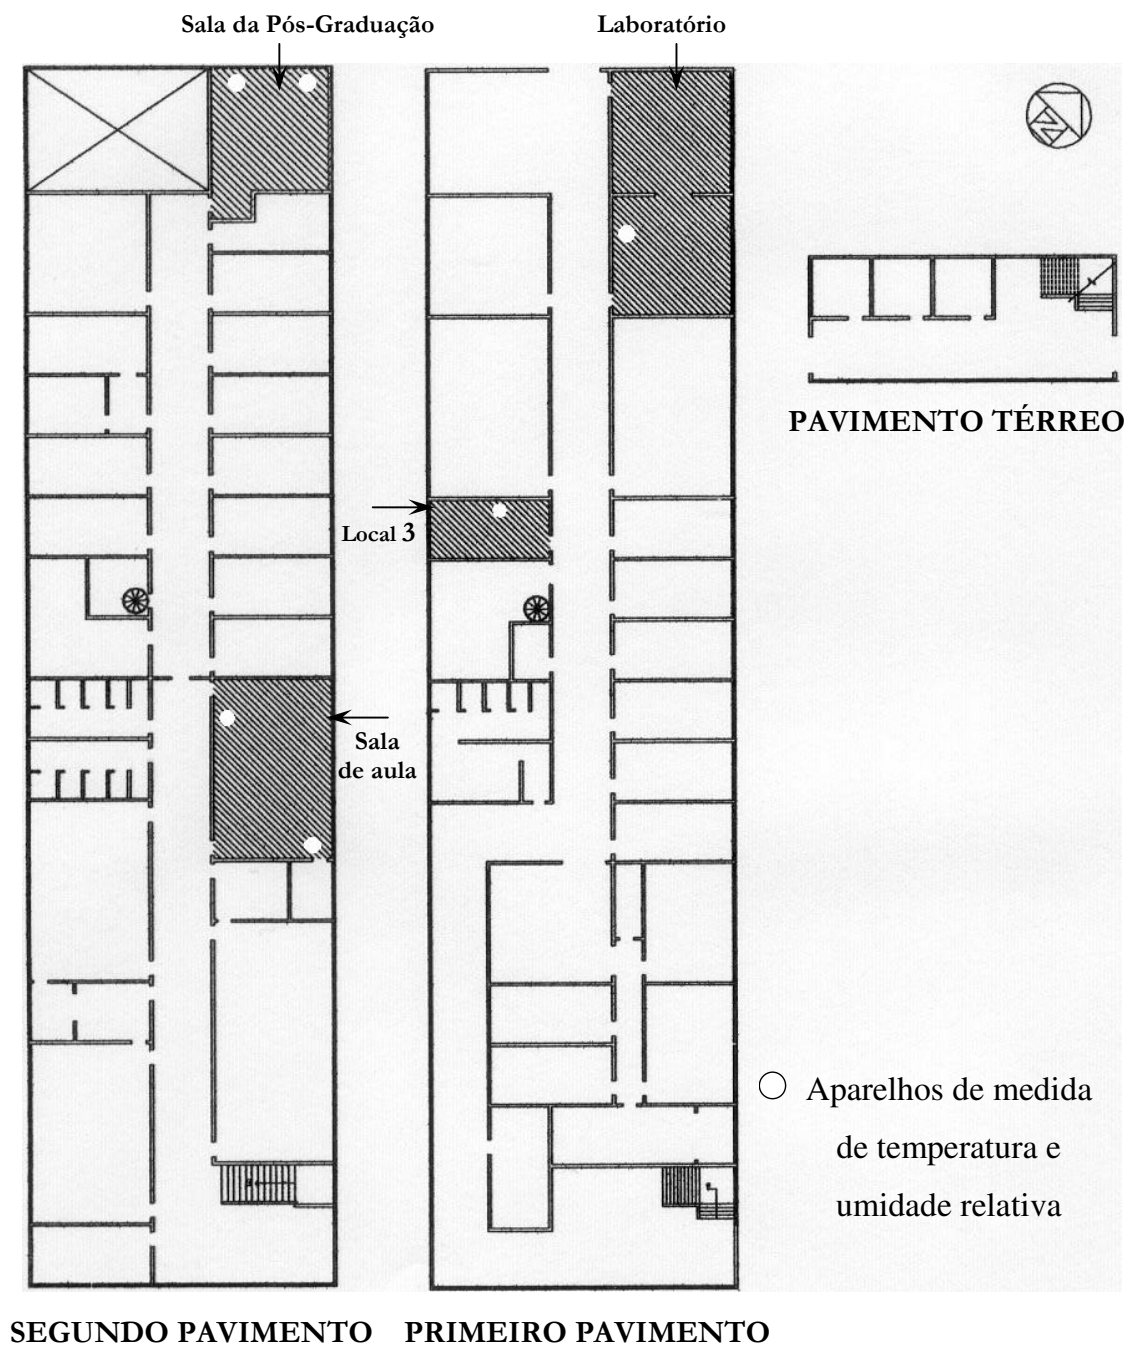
Planta Baixa do Bloco I – Escala 1:100
